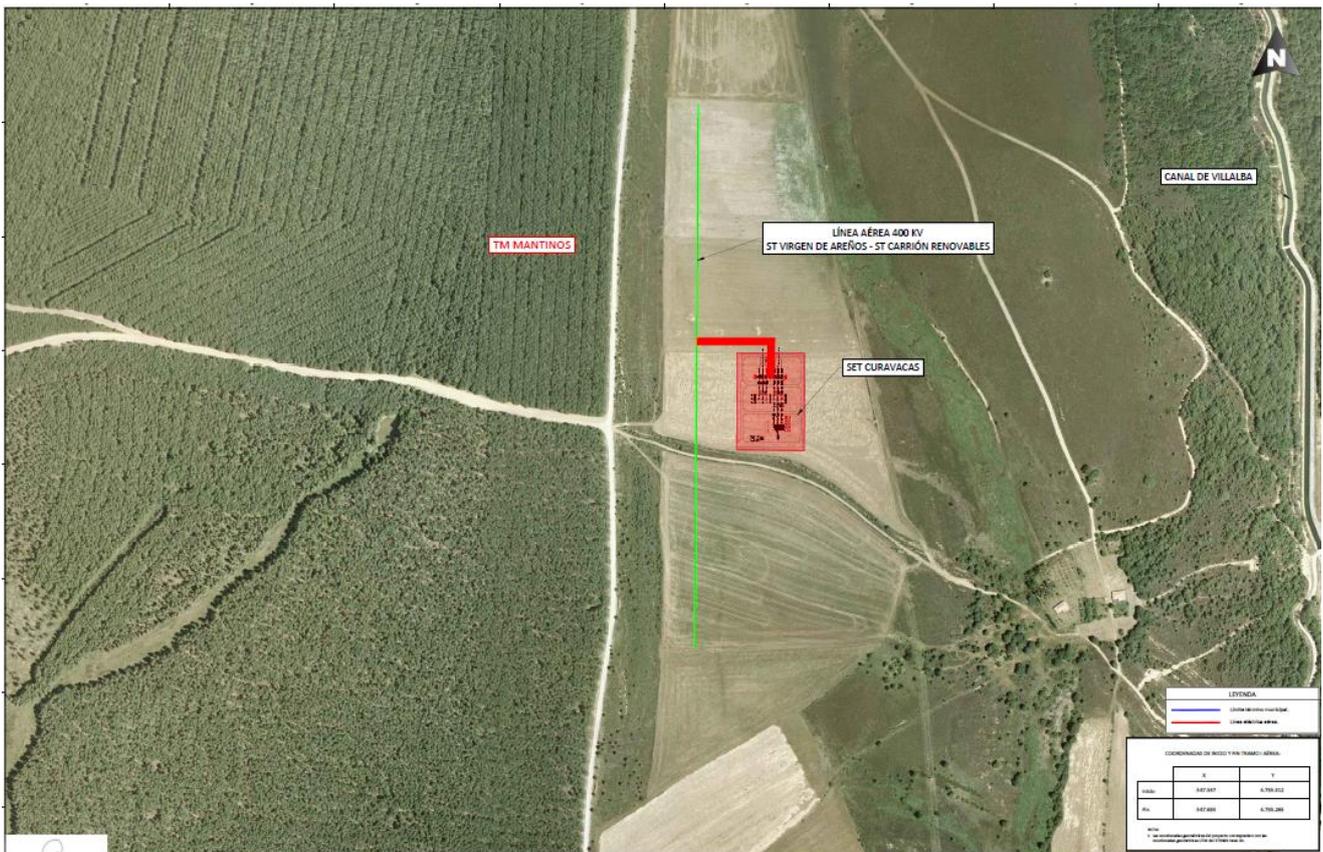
Emplazamiento de Entronque a Línea Aérea 400kV ST Virgen de Areños - ST Carrión Renovables para conexión con SET Curavacas
